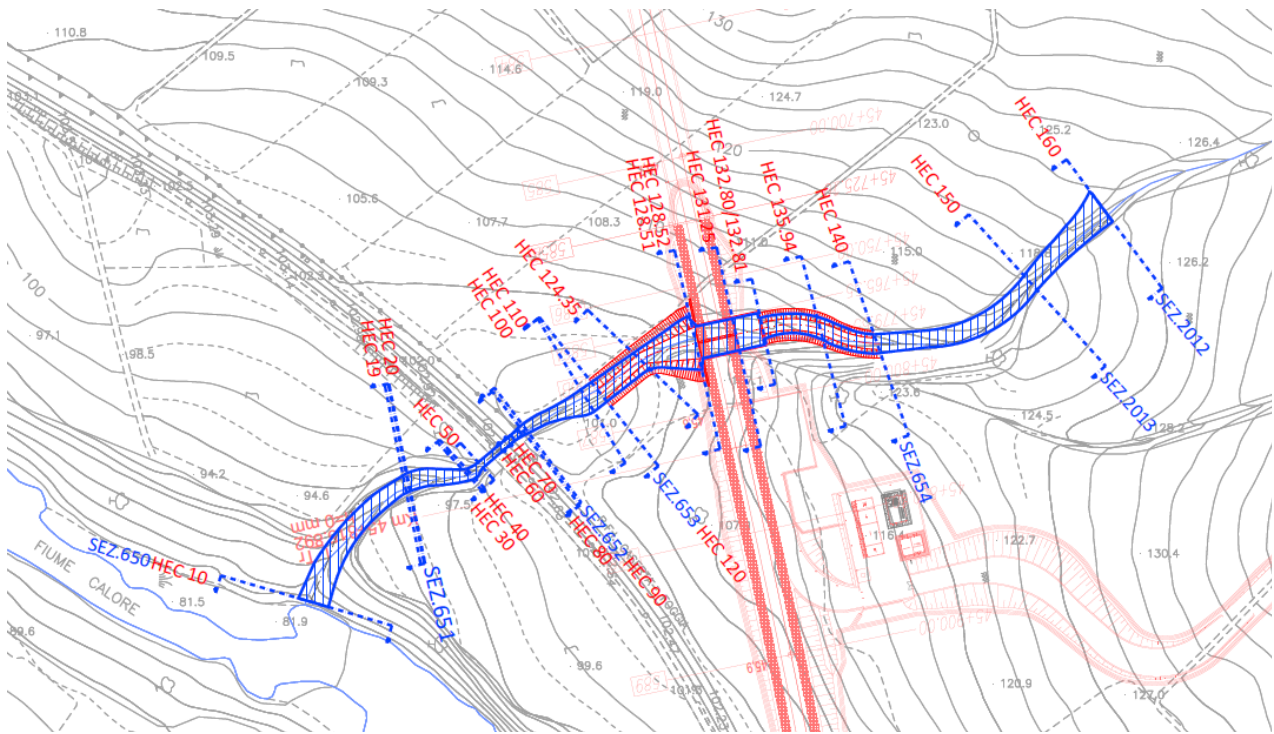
Vallone del Fangara – pk 45+773 - planimetria di esondazione post operam.
